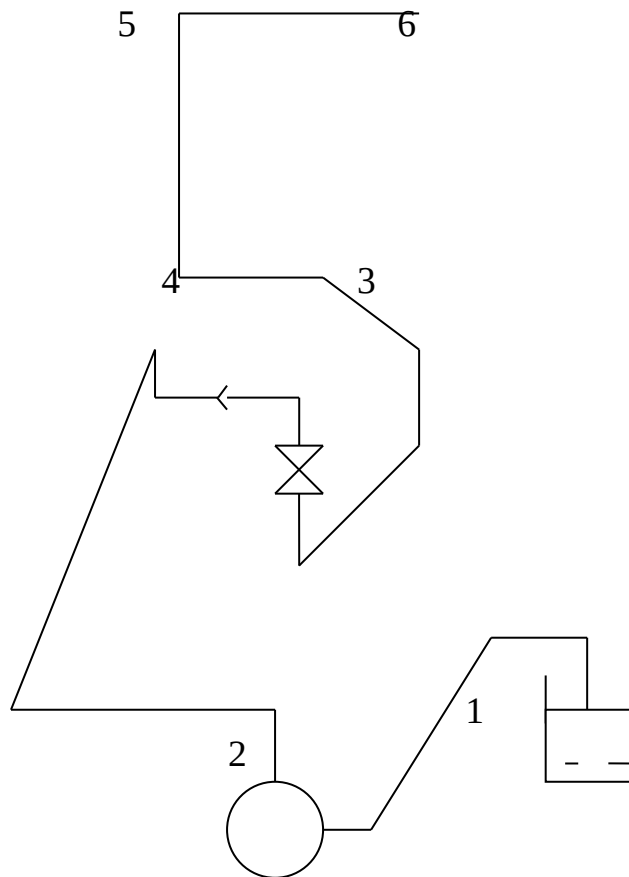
Схема трубопроводу до прикладу розрахунку
